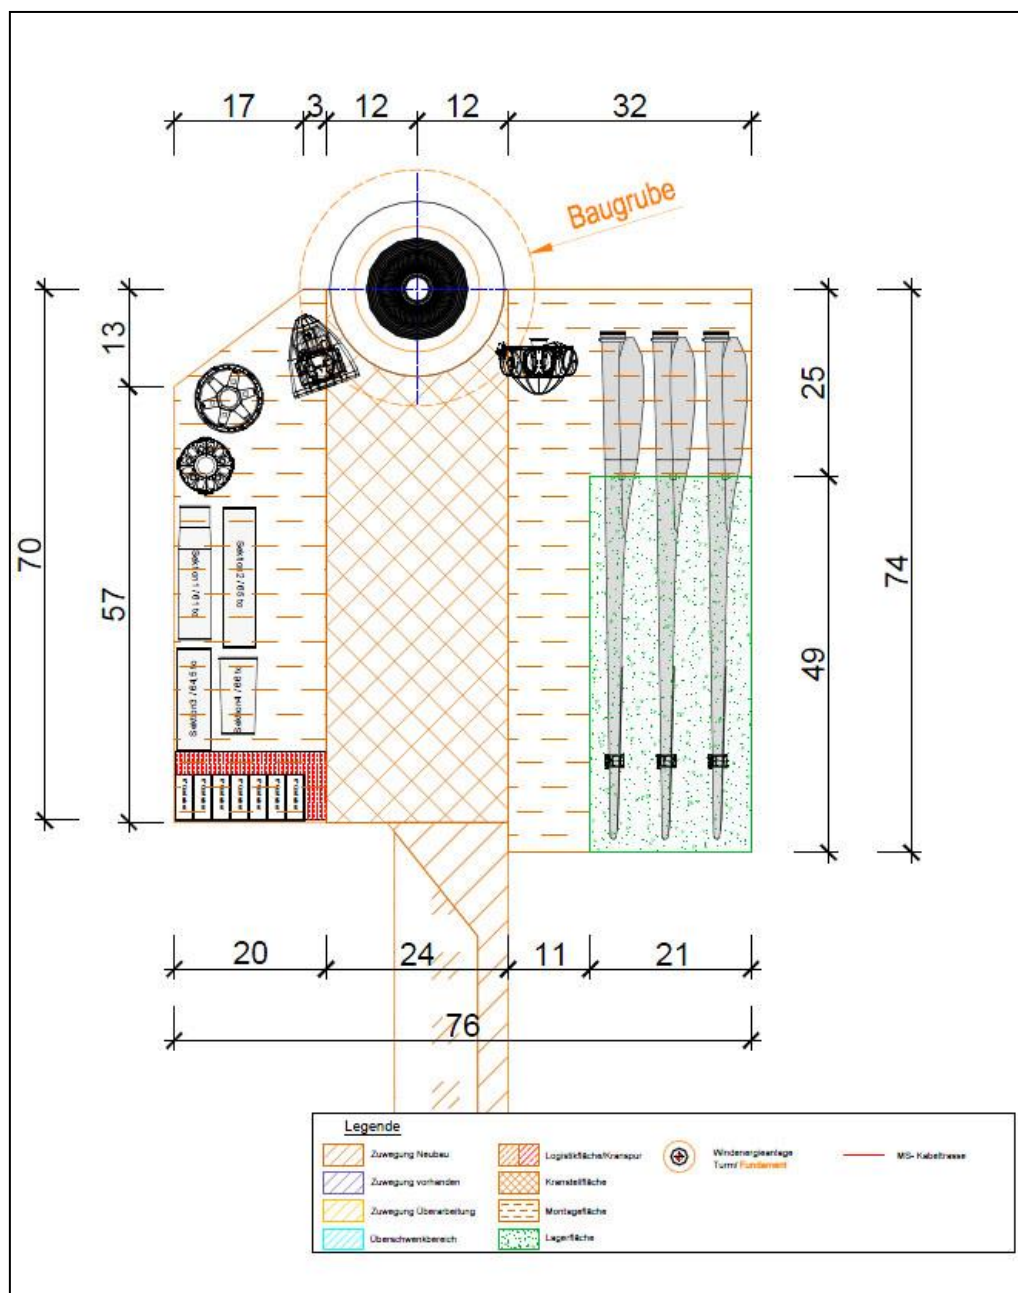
Beispiel-Lageplan der geplanten WEA (E-141)
